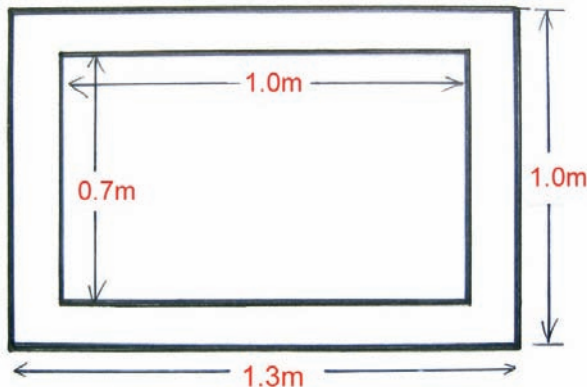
Un moule de dalle fait avec des briques et du bois.
